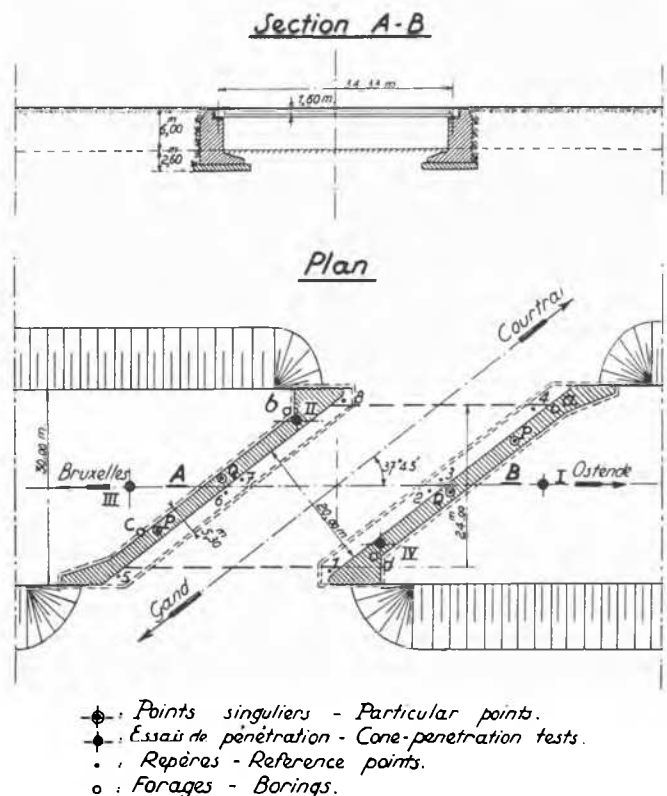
Pont No. 14 at St-Denis-Westrem: vue en plan et coupe; les tassements ont été calculés aux points P et Q
